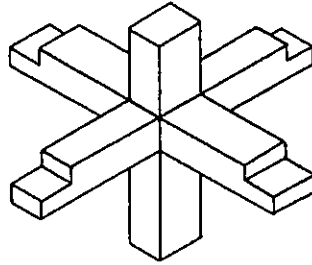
Columna prefabricada con cuatro ménsulas largas
